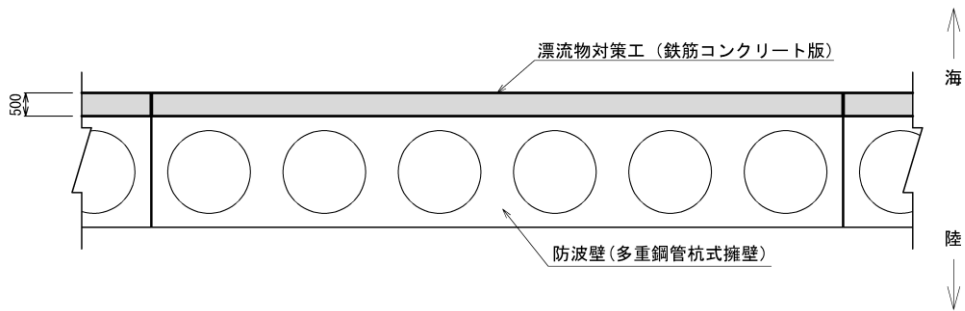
(1) 漂流物対策工（鉄筋コンクリート版）の構造概要図（平面図）
